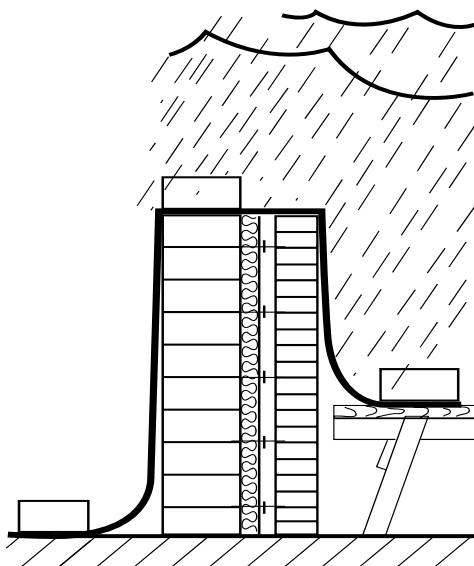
Предохранение возводимой каменной кладки многослойных стен от атмосферных осадков [8]
